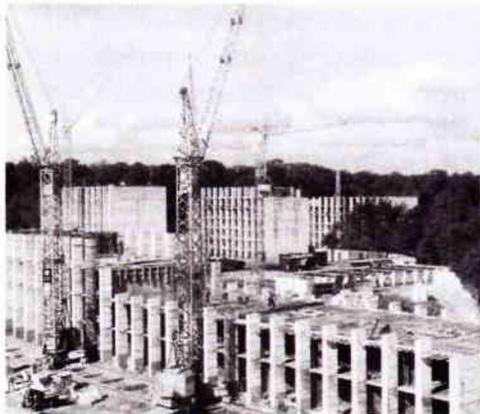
et 2 - La construction de Meudon-la-Forêt avec utilisation de la pierre de Fontvieille (crédit : Ville de Meudon).
